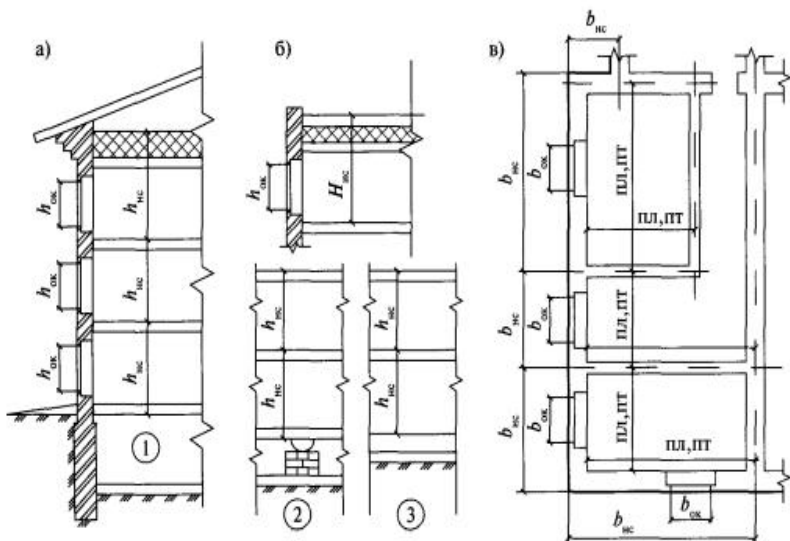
Определение размеров ограждающих конструкций при расчёте теплопотерь помещениями (НС – наружных стен, Пл – пола, Пт – потолка, ОК – окон): 1 – неотапливаемый подвал; 2 – пол по лагам; 3 – пол на грунте
